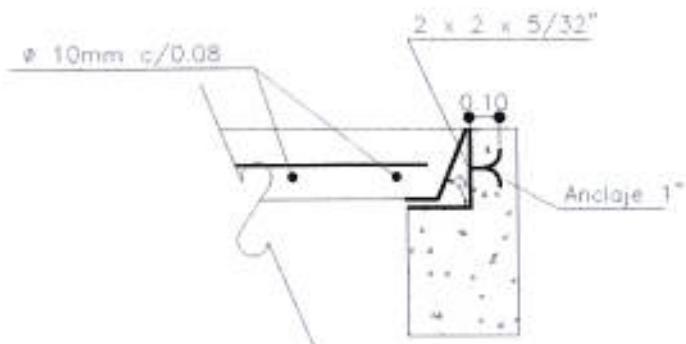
diferentes vistas de la tapa de hormigón armado en acera
